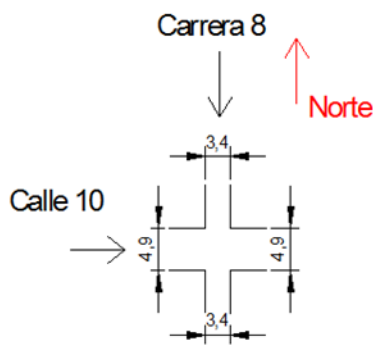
Esquema en planta del punto de estudio cruce carrera 8 y calle 10
